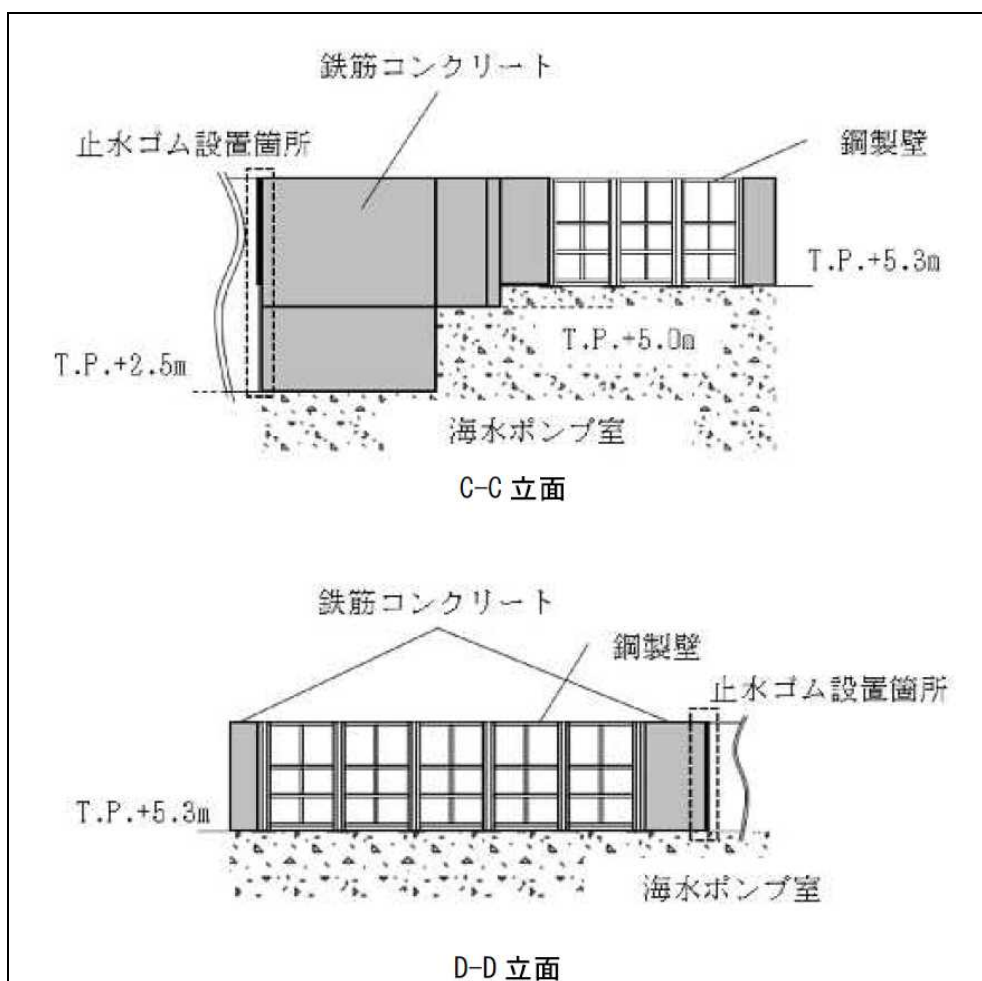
止水壁立面図及び断面図 (2/2) (関西電力 大飯 3, 4 号炉)
